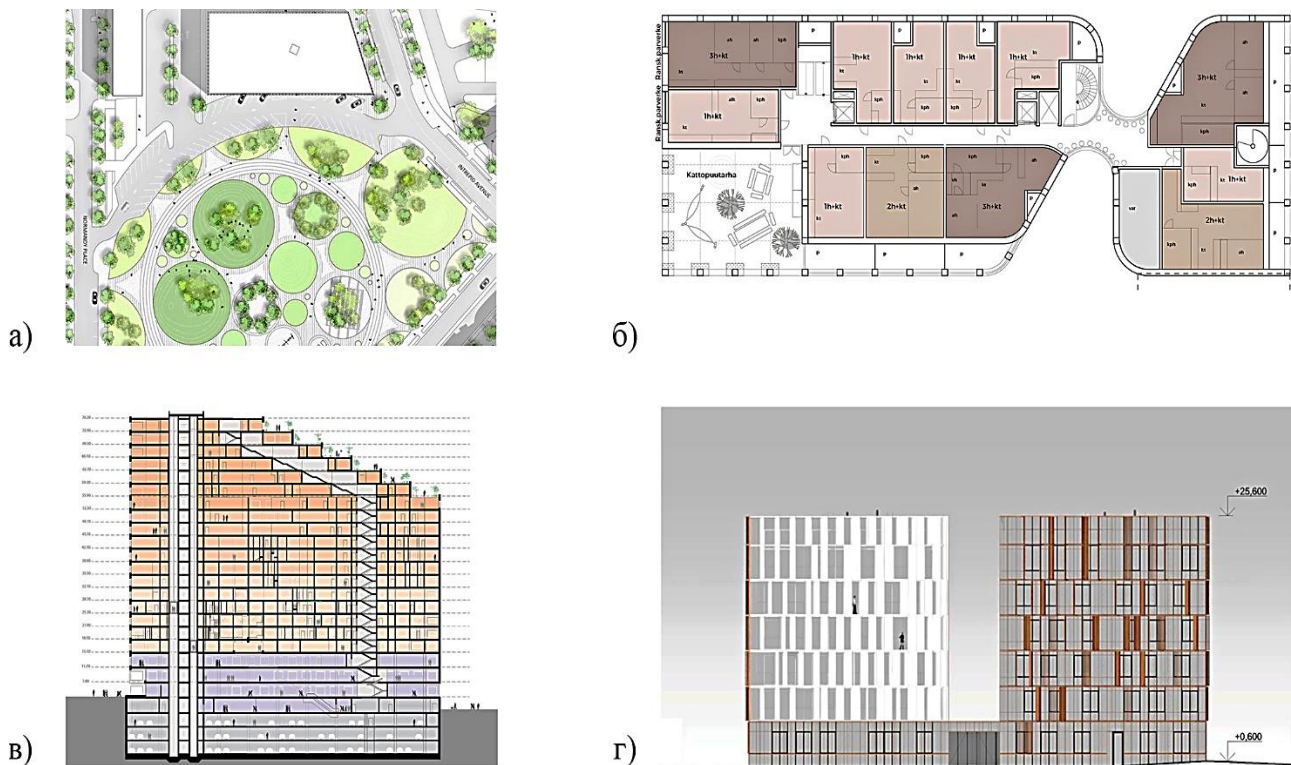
а) генеральный план проекта «1200 INTREPID», бюро «BIG», Филадельфия, США [7]; б) план проекта «Tulli Halls», бюро «Schauman Nordgren Architects», Тампере, Финляндия [8]; в) разрез жилого комплекса «RED7», бюро «MVRDV», Москва, Россия [9]; г) фасад жилого дома на 2-ом Донском проезде, бюро «Sergey Skuratov Architects», Москва, Россия [10].
